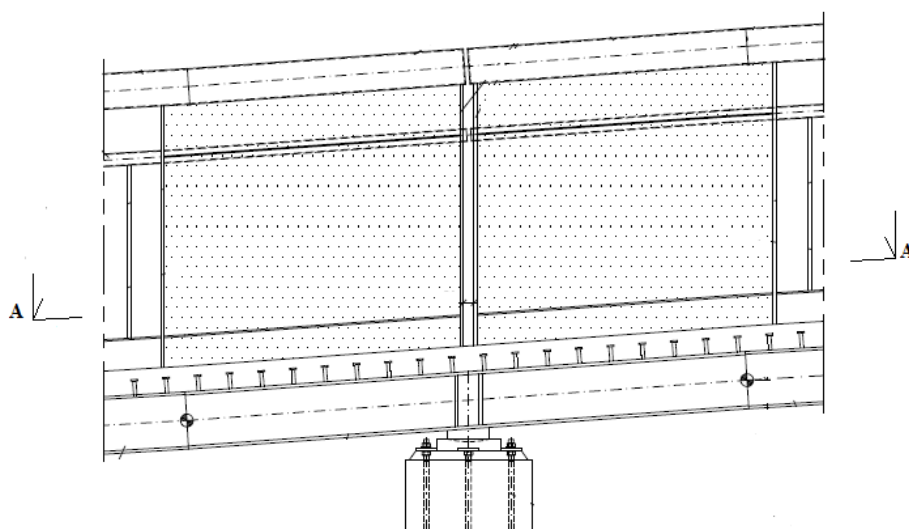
Corte longitudinal do tabuleiro na zona dos pilares, com vista para as chapas de aço integradas nas guardas [25].
